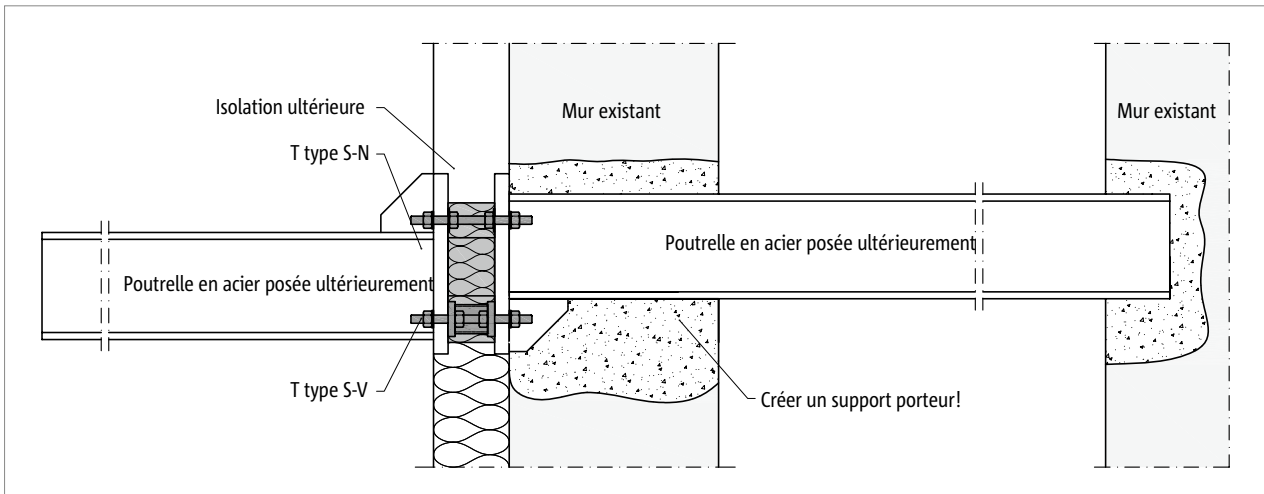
Schöck Isokorb® T type S-N et T type S-V : balcon en acier en porte-à-faux libre posé ultérieurement ; raccordé à des poutres en acier installées ultérieurement avec décalage en hauteur
